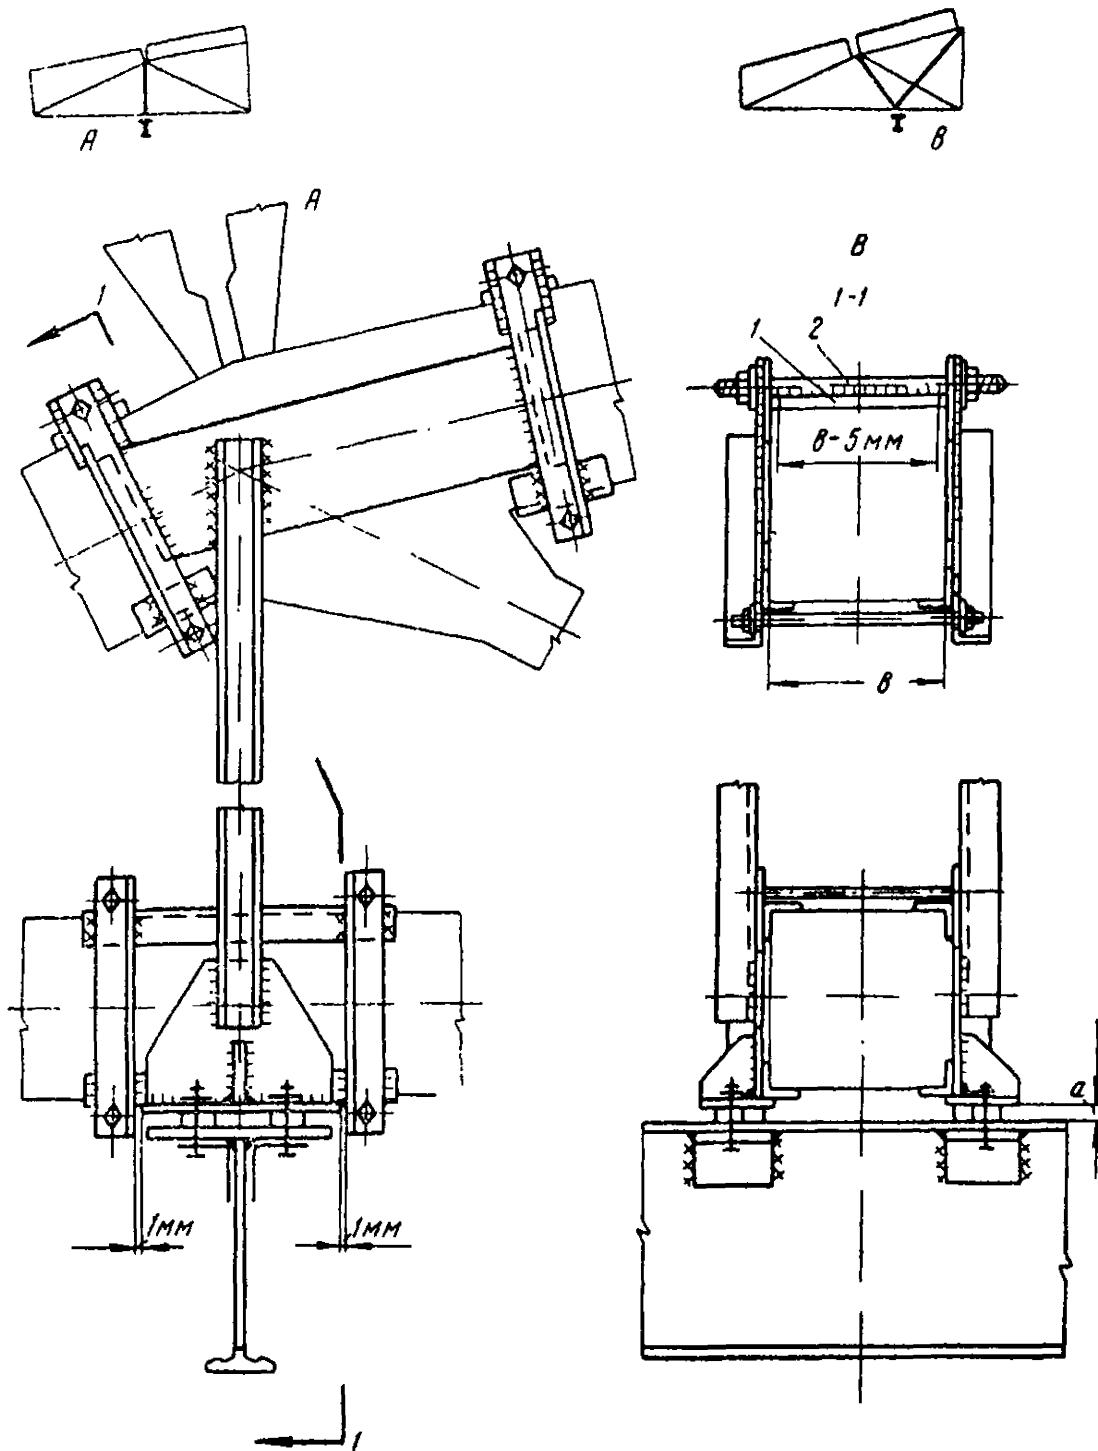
Подвеска балки к железобетонной ферме на хомутах
